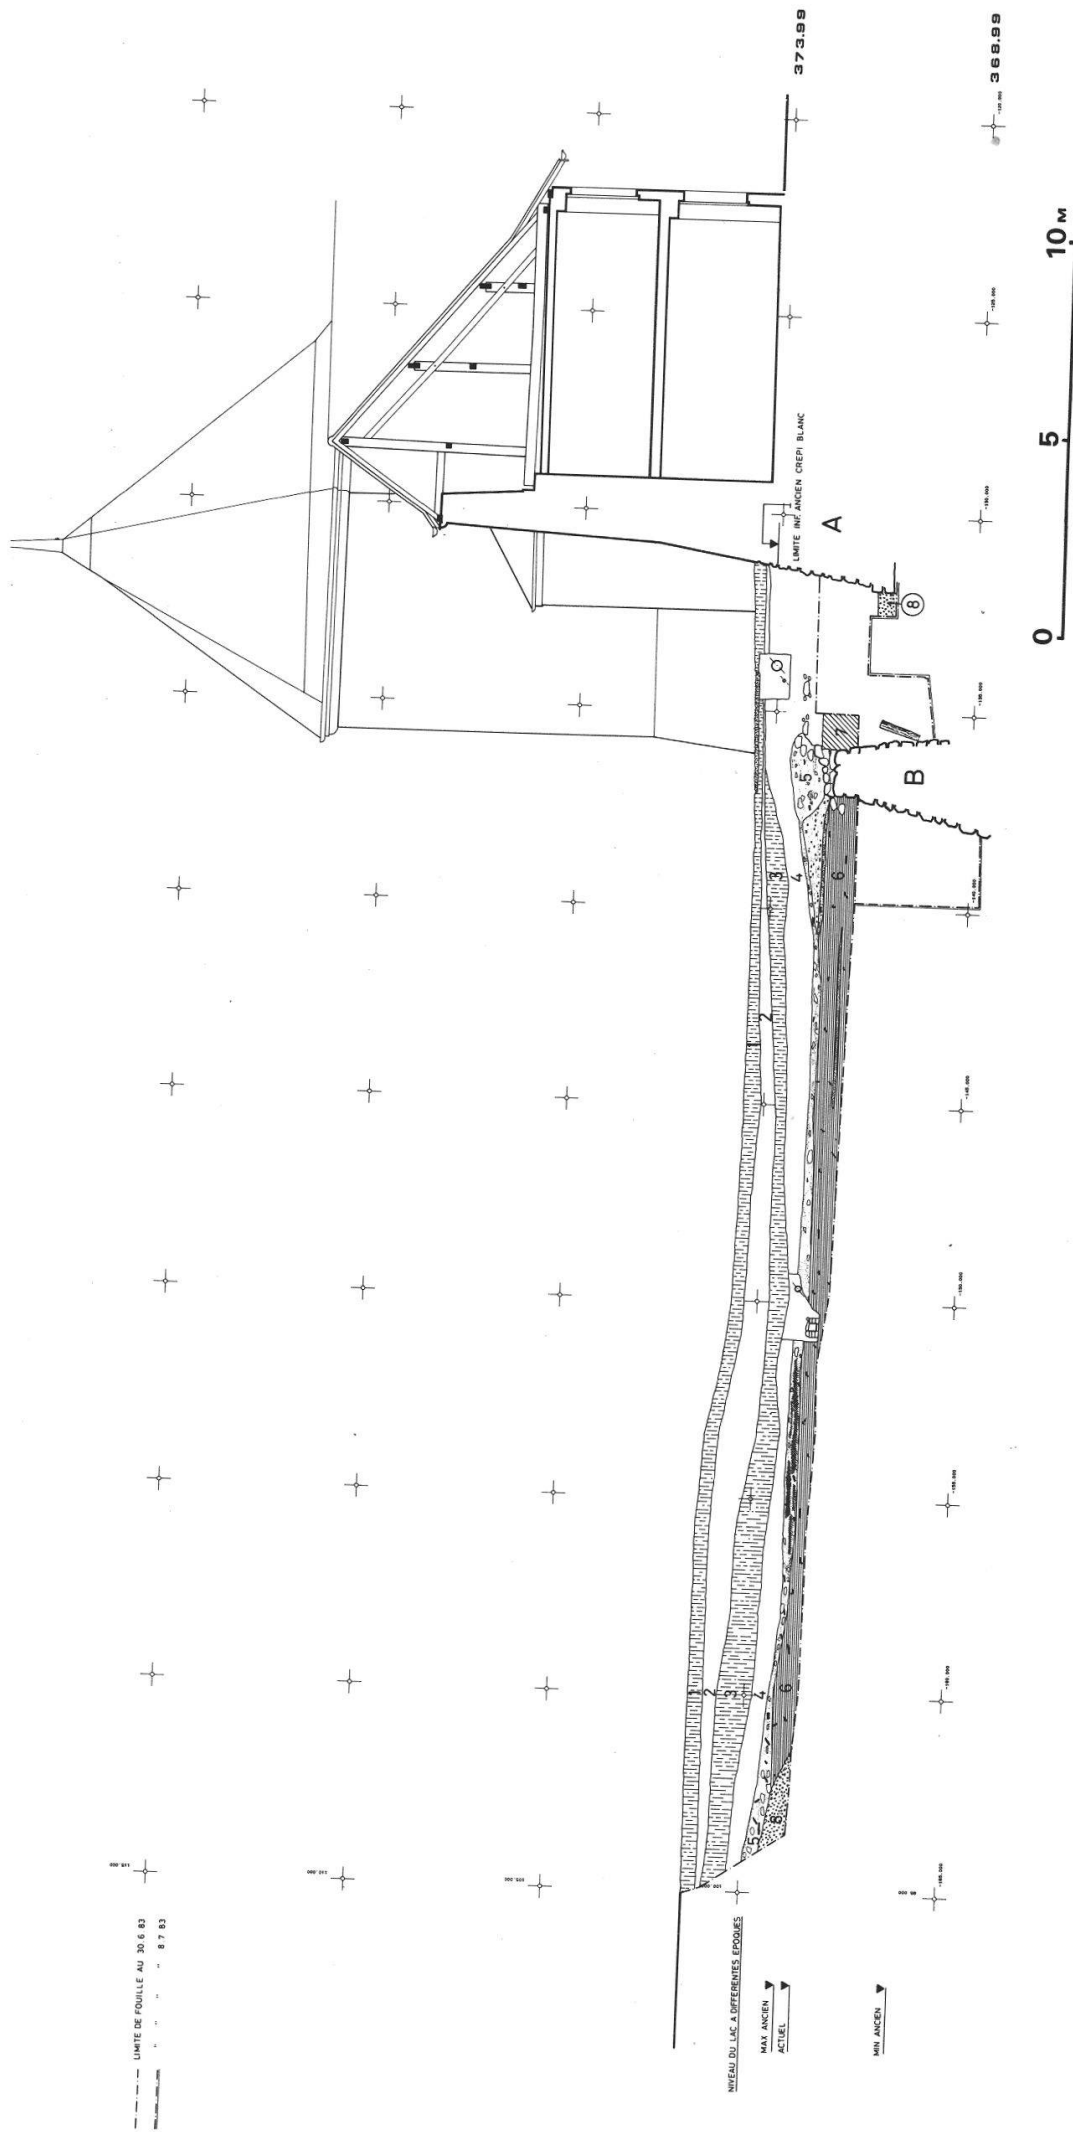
Rolle - Château - Coupe transversale du fossé et du mur de braie.
